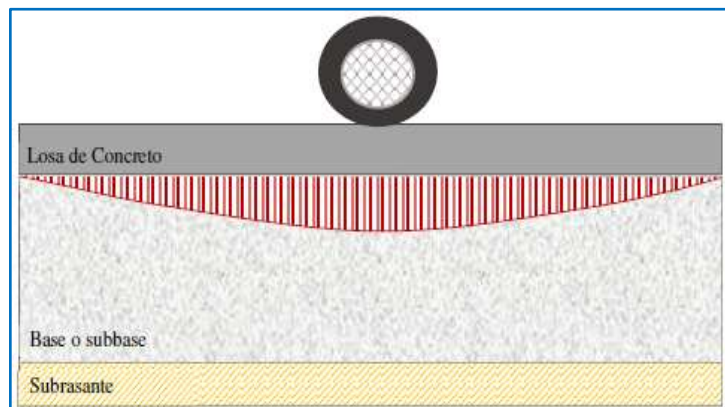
Estructura y distribución de cargas en pavimento rígido
